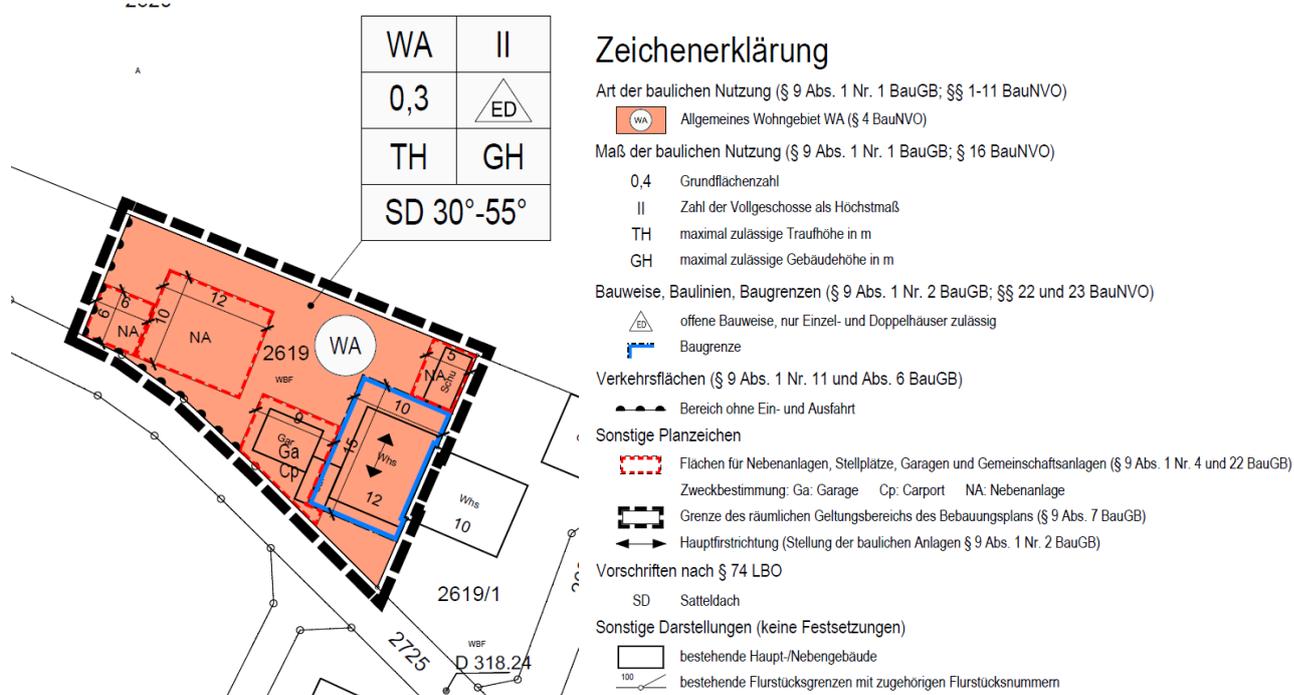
Bebauungsplan „Kirchstraße I“ (Quelle: die STEG, Stand: 20.01.2025)
